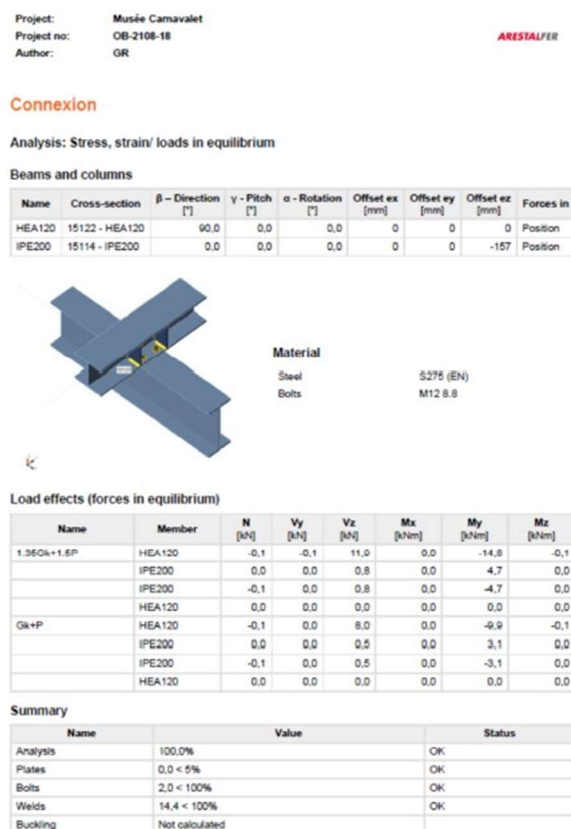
Ligação aparafusada viga-viga – Musée Carnavalet: pórtico metálico 1
